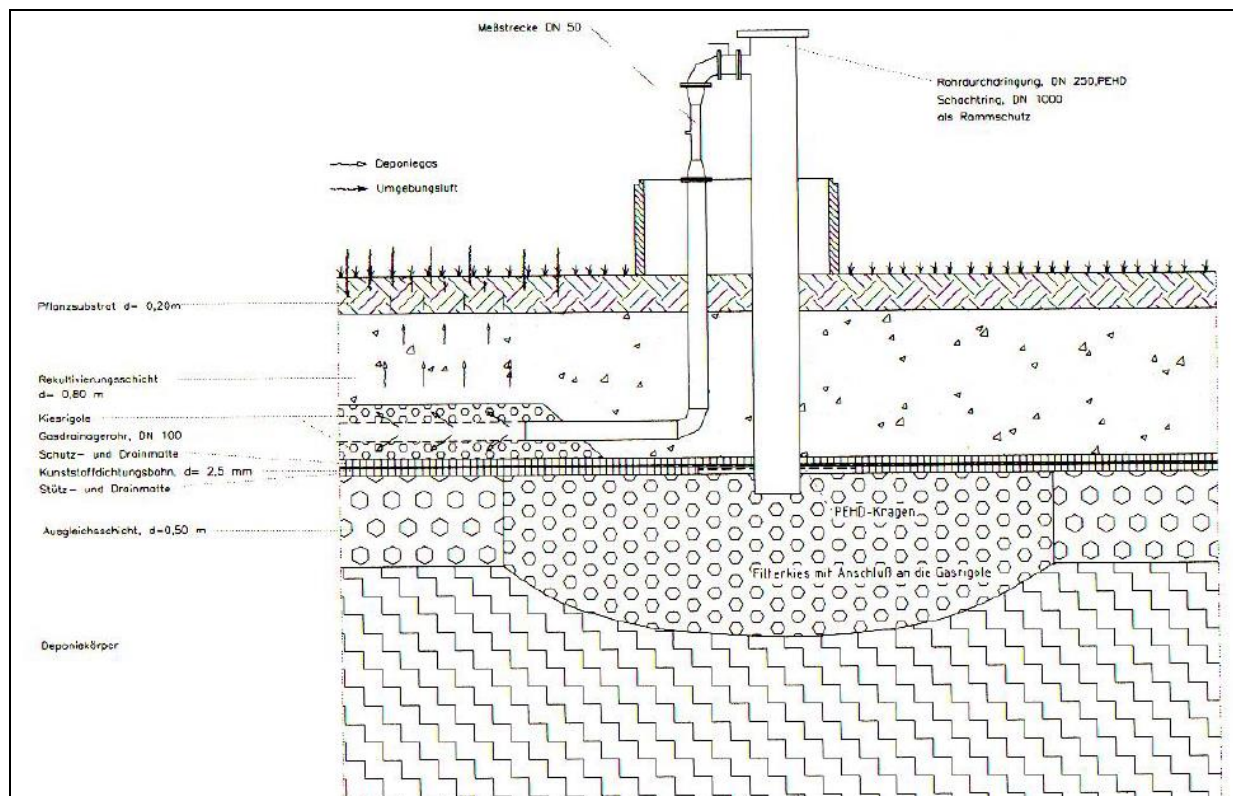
Aufbau einer Oberflächenabdichtung mit Rekultivierungsschicht zur Methanoxidation (Rettenberger, 2006)
